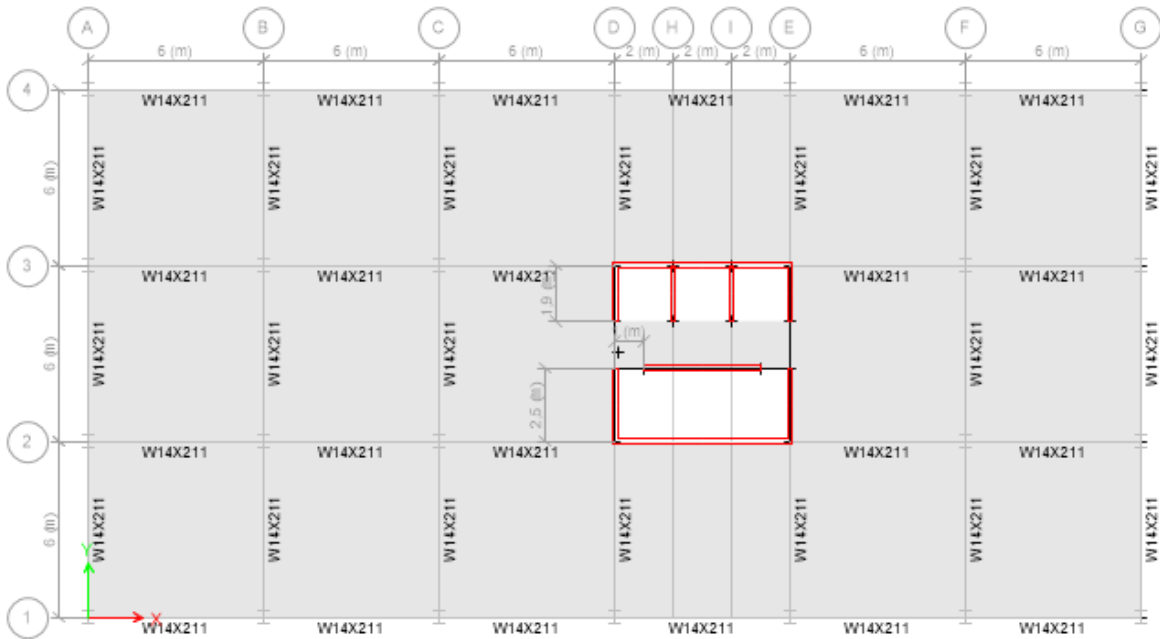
11: Vista en planta de las vigas correspondiente a los pisos 7-12, edificio tipo B.
